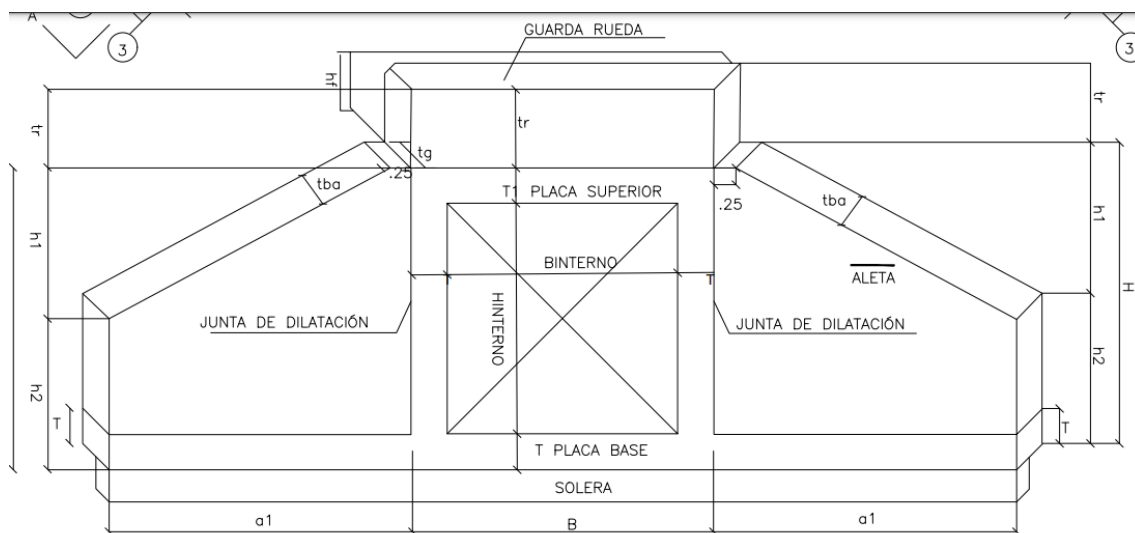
Vista frontal de Box Culvert tipo. Fuente: Manual de obras menores de drenaje y estructuras viales. INVIAS 2020.
